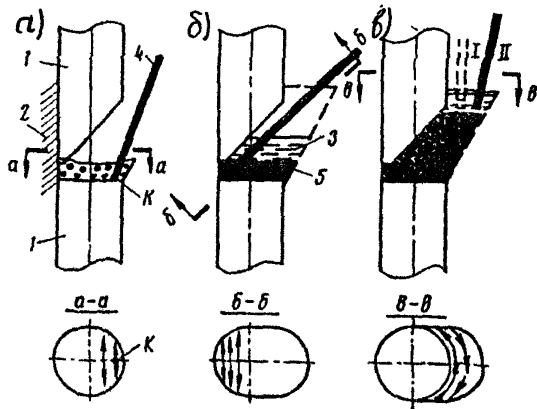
Техника вапной сварки под флюсом стыковых соединений вертикальных стержней диаметром ≤ 32 мм
